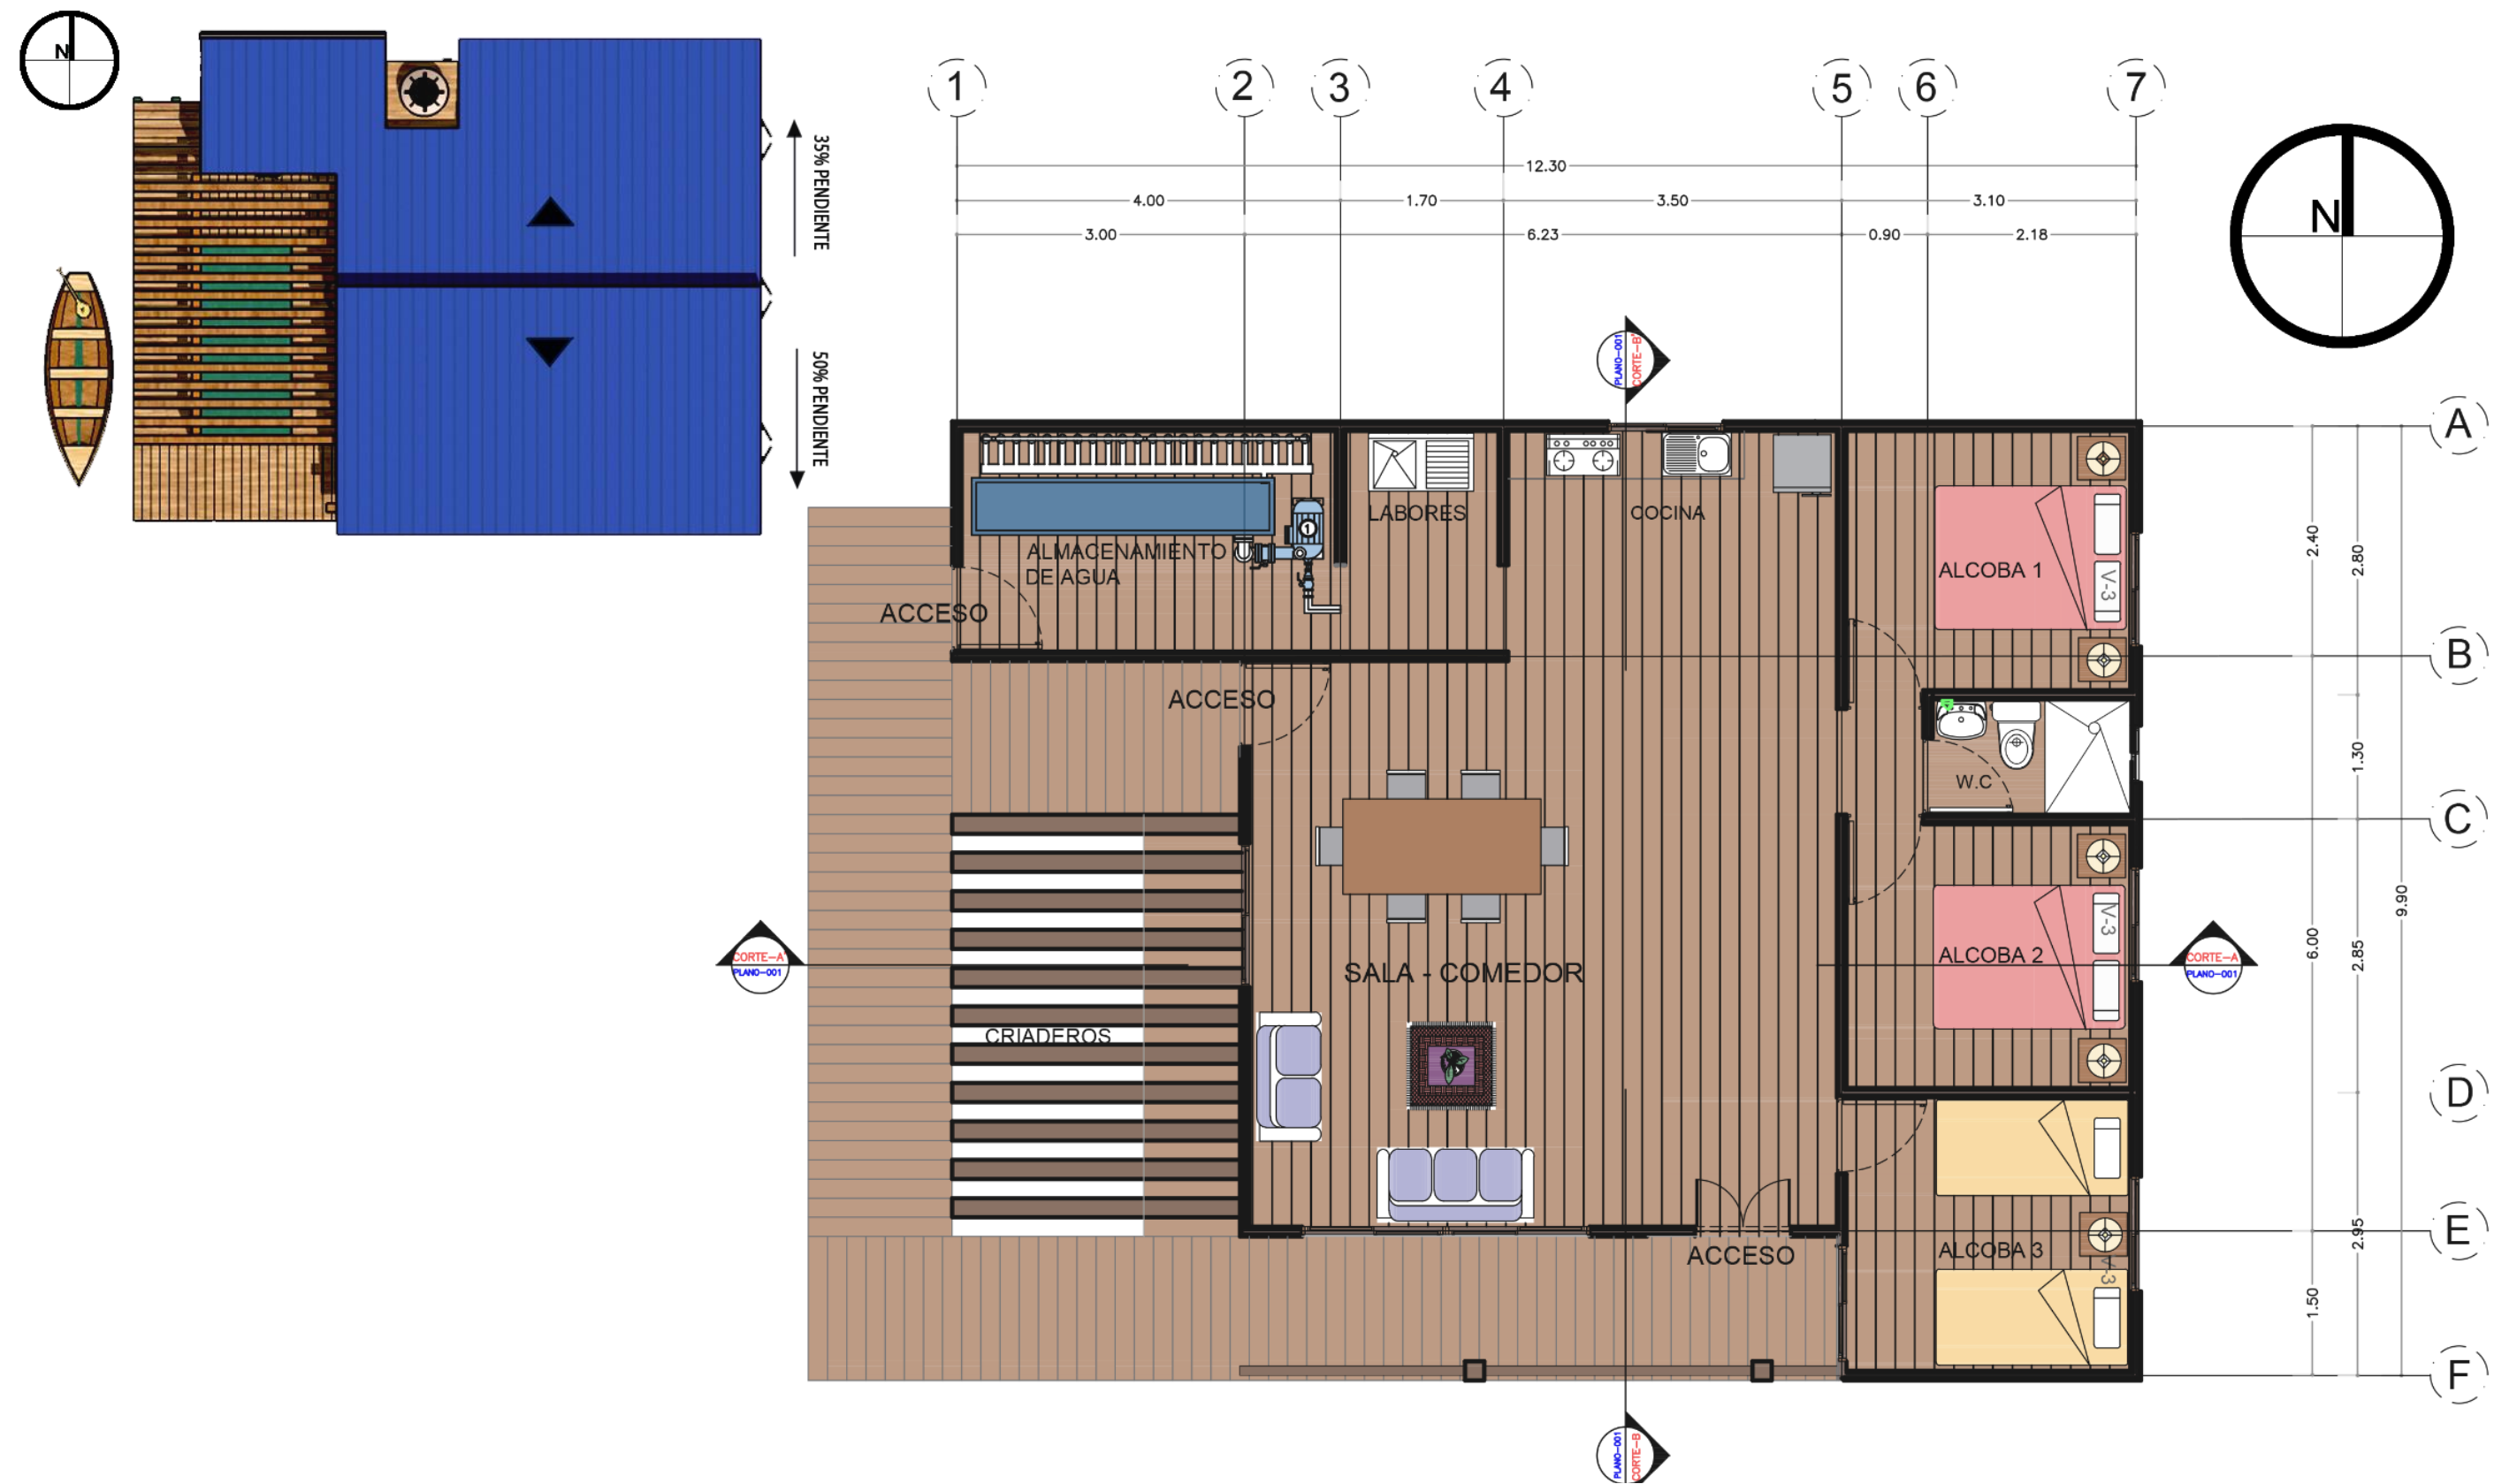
Implantación y planta general vivienda modelo. Fuente: Elaboración propia
